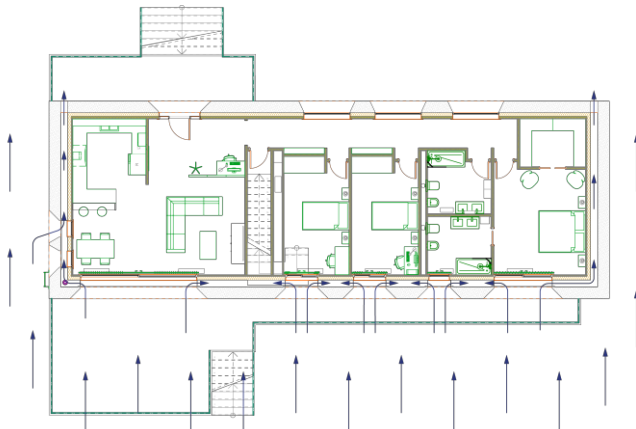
Ventilación de fachada. 2016. Fuente propia
